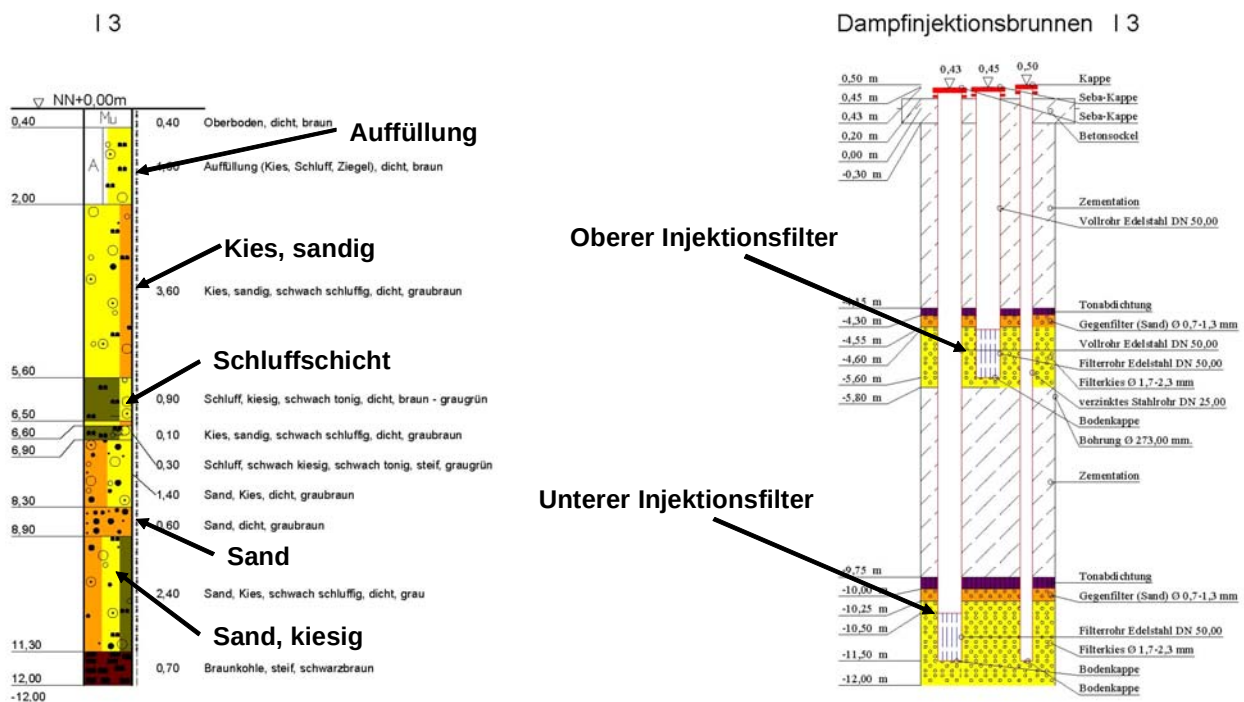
Bohrprofil und Brunnenbau Injektionsbrunnen I3
